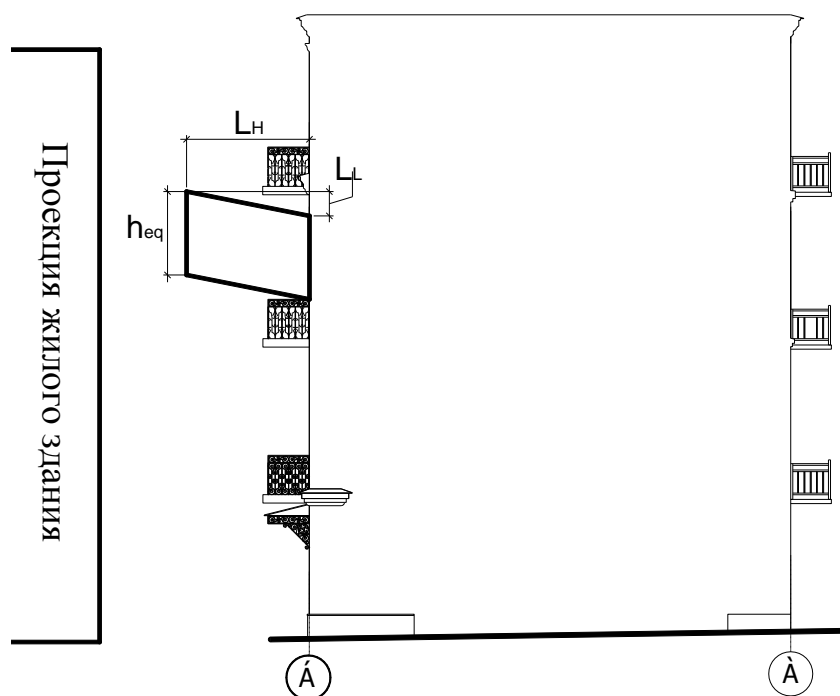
Вертикальная проекция пламени на фасаде здания
